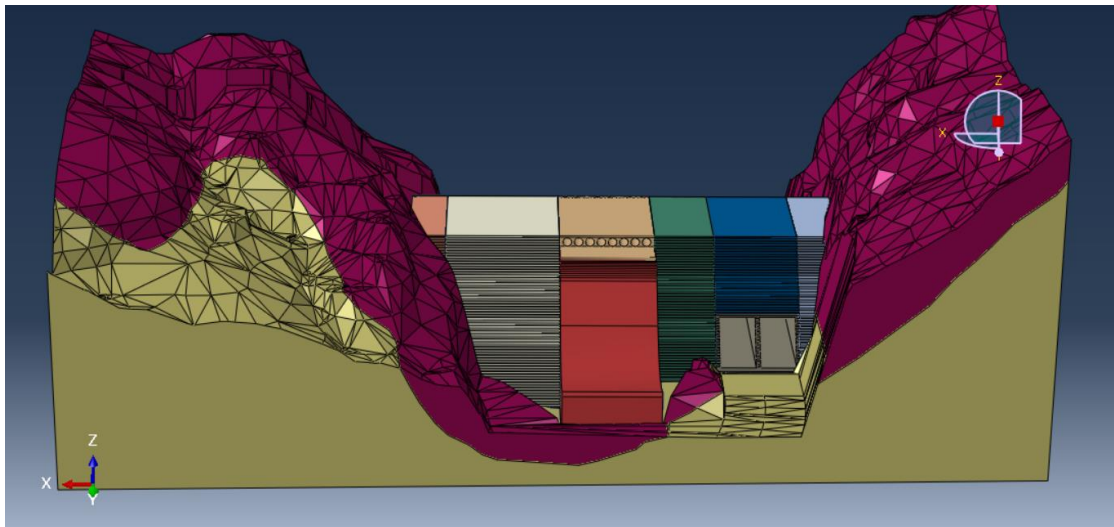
Geometría tridimensional de la cortina de la presa Pilares en la etapa 5 de construcción, en la elevación 192.90 msnm.
